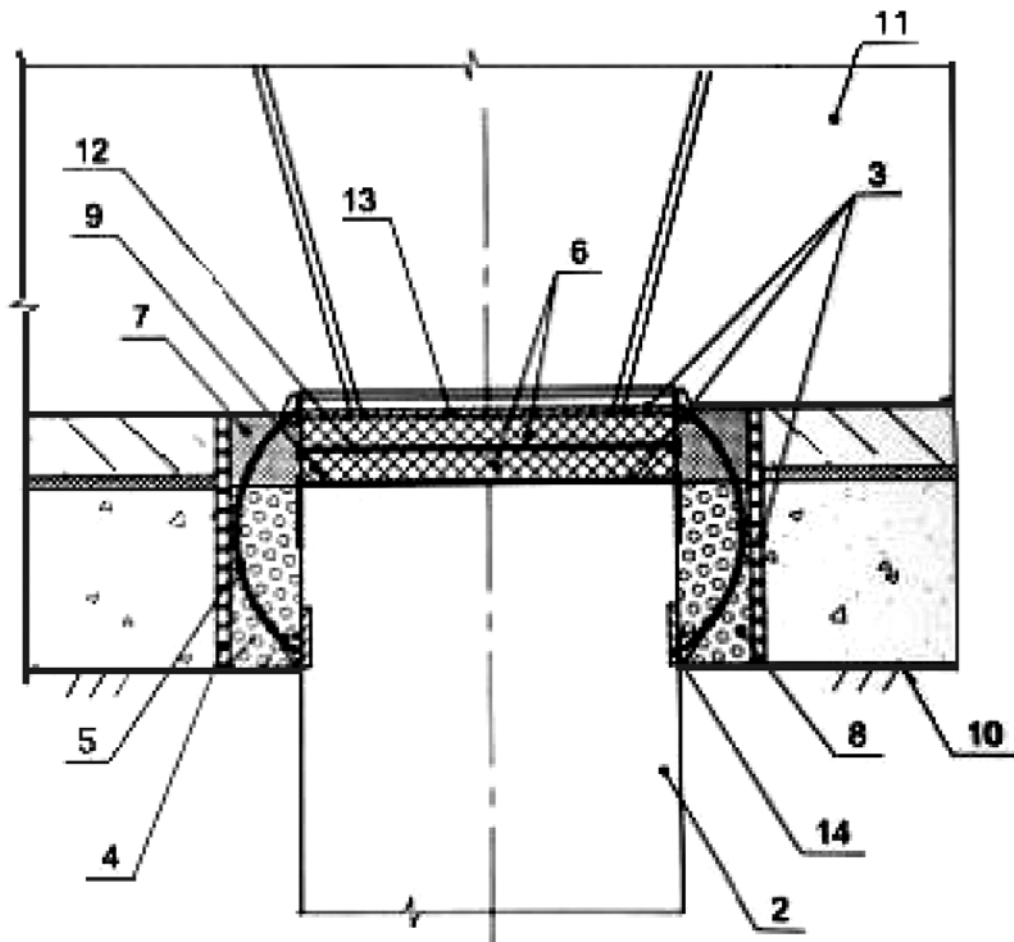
Принципиальная схема установки демпферной конструкции на оголовок сваи
